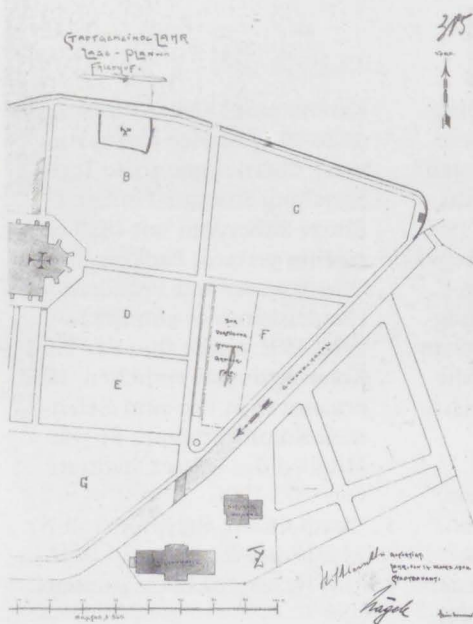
Östlicher Ausschnitt aus dem Lageplan des alten Friedhofs.
